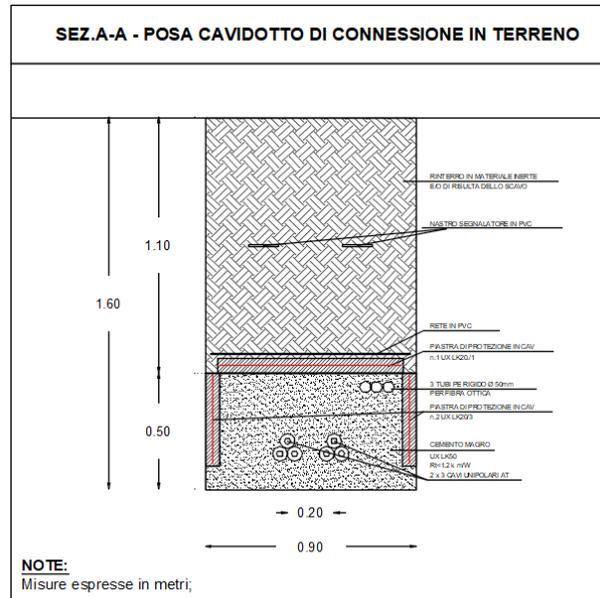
Tipologico di posa in terreno per il cavidotto di connessione
